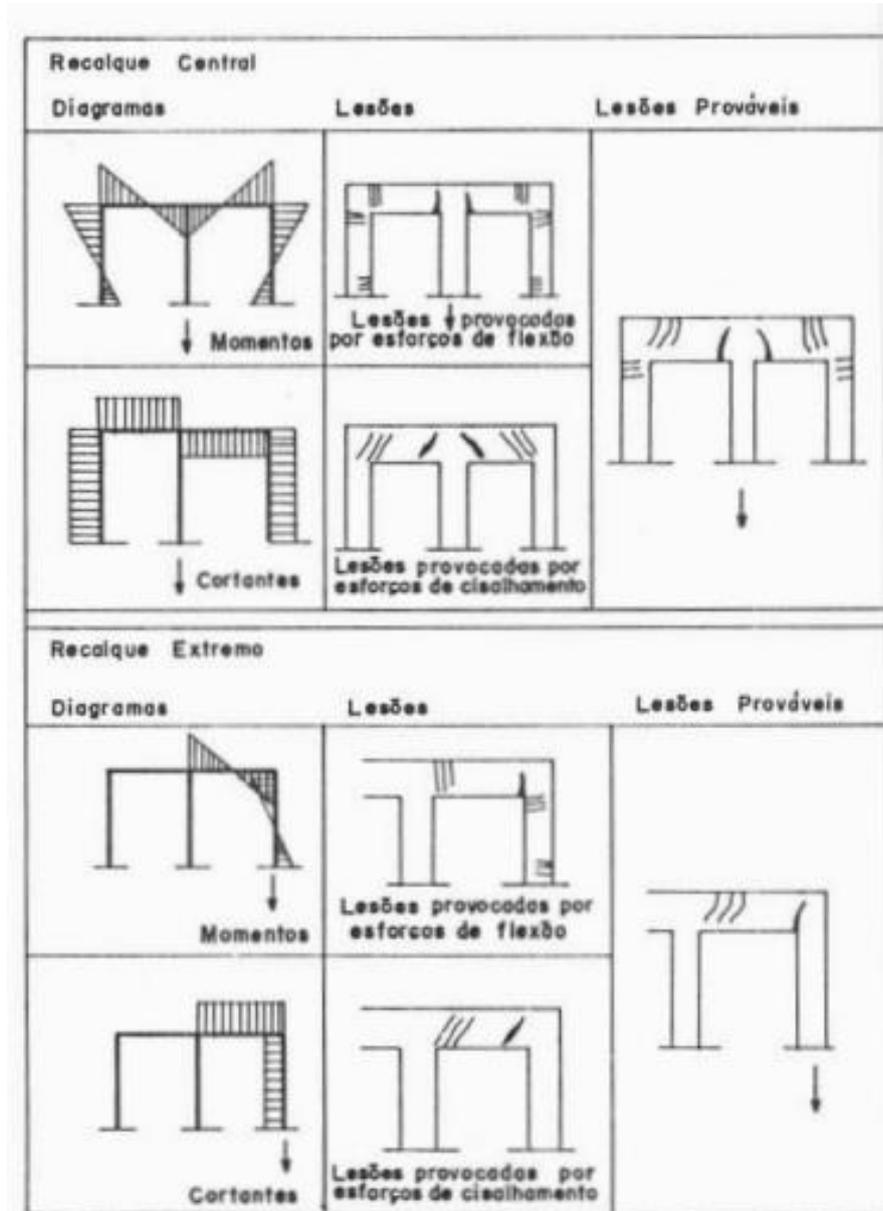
Fissura por recalque diferencial em paredes de concreto
